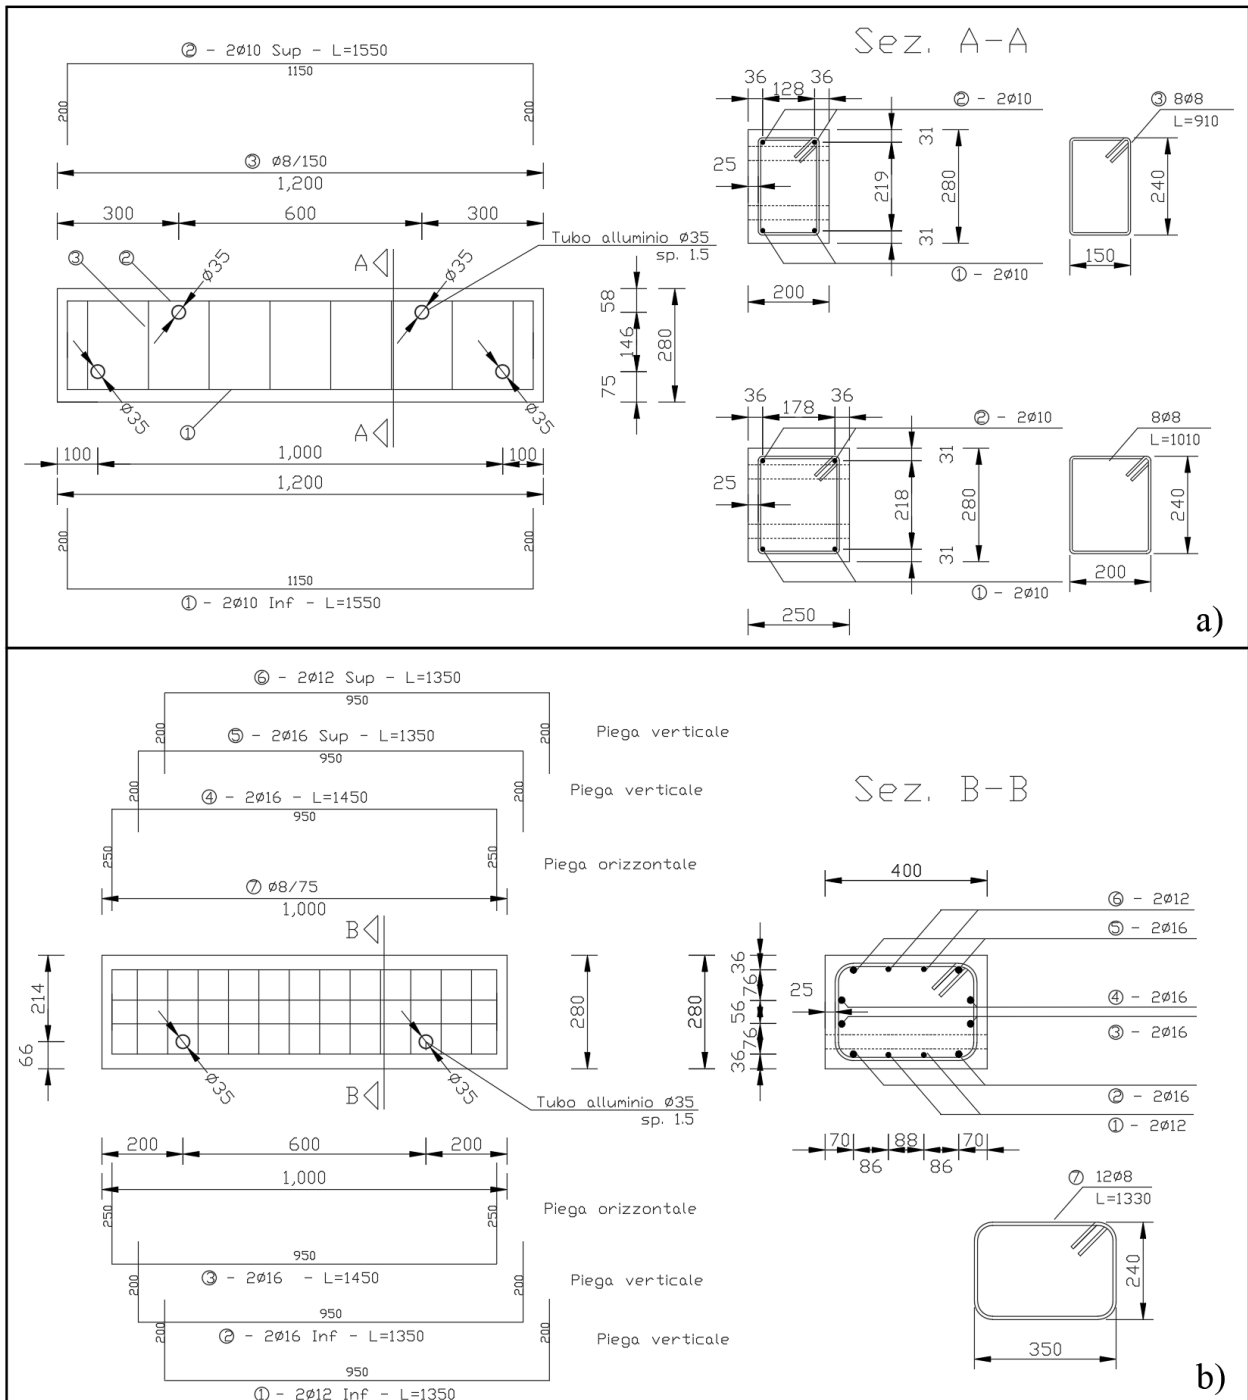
Prove di taglio ortogonale: Particolari costruttivi dei provini di cls: Armatura dell'elemento di calcestruzzo debolmente armato ("cordolo") (a) e armatura dell'elemento di calcestruzzo fortemente armato ("traverso")(b)
